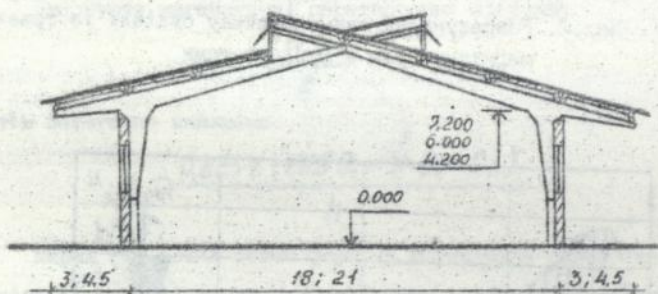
Розрахункова схема каркасу будівлі із трьохшарнірних рам з фундаментами
